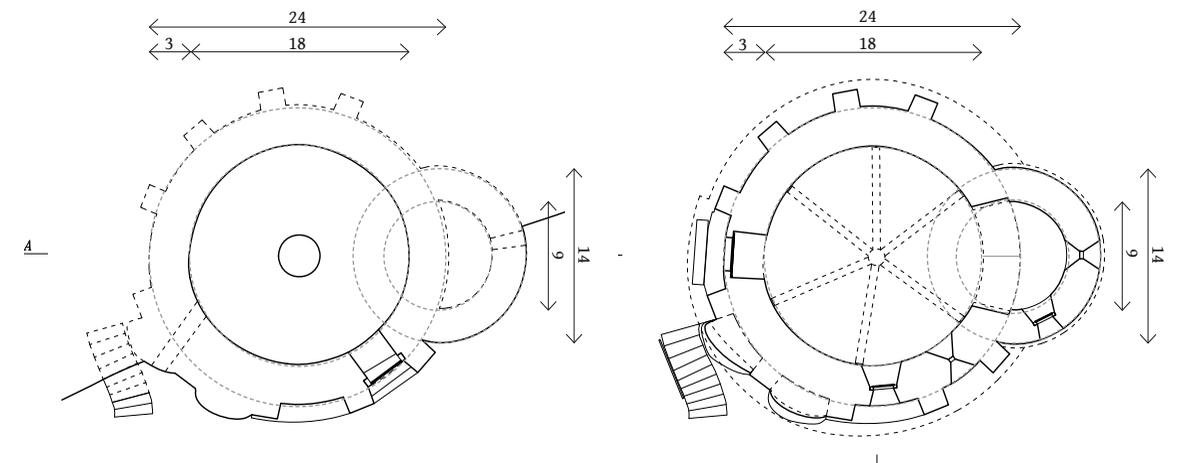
Grundrisse mit den kodierten Hauptmaßen in Fuß. CA 2016.
